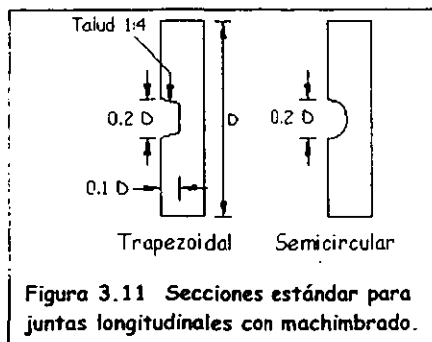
Secciones estándar para juntas longitudinales con machimbrado.
